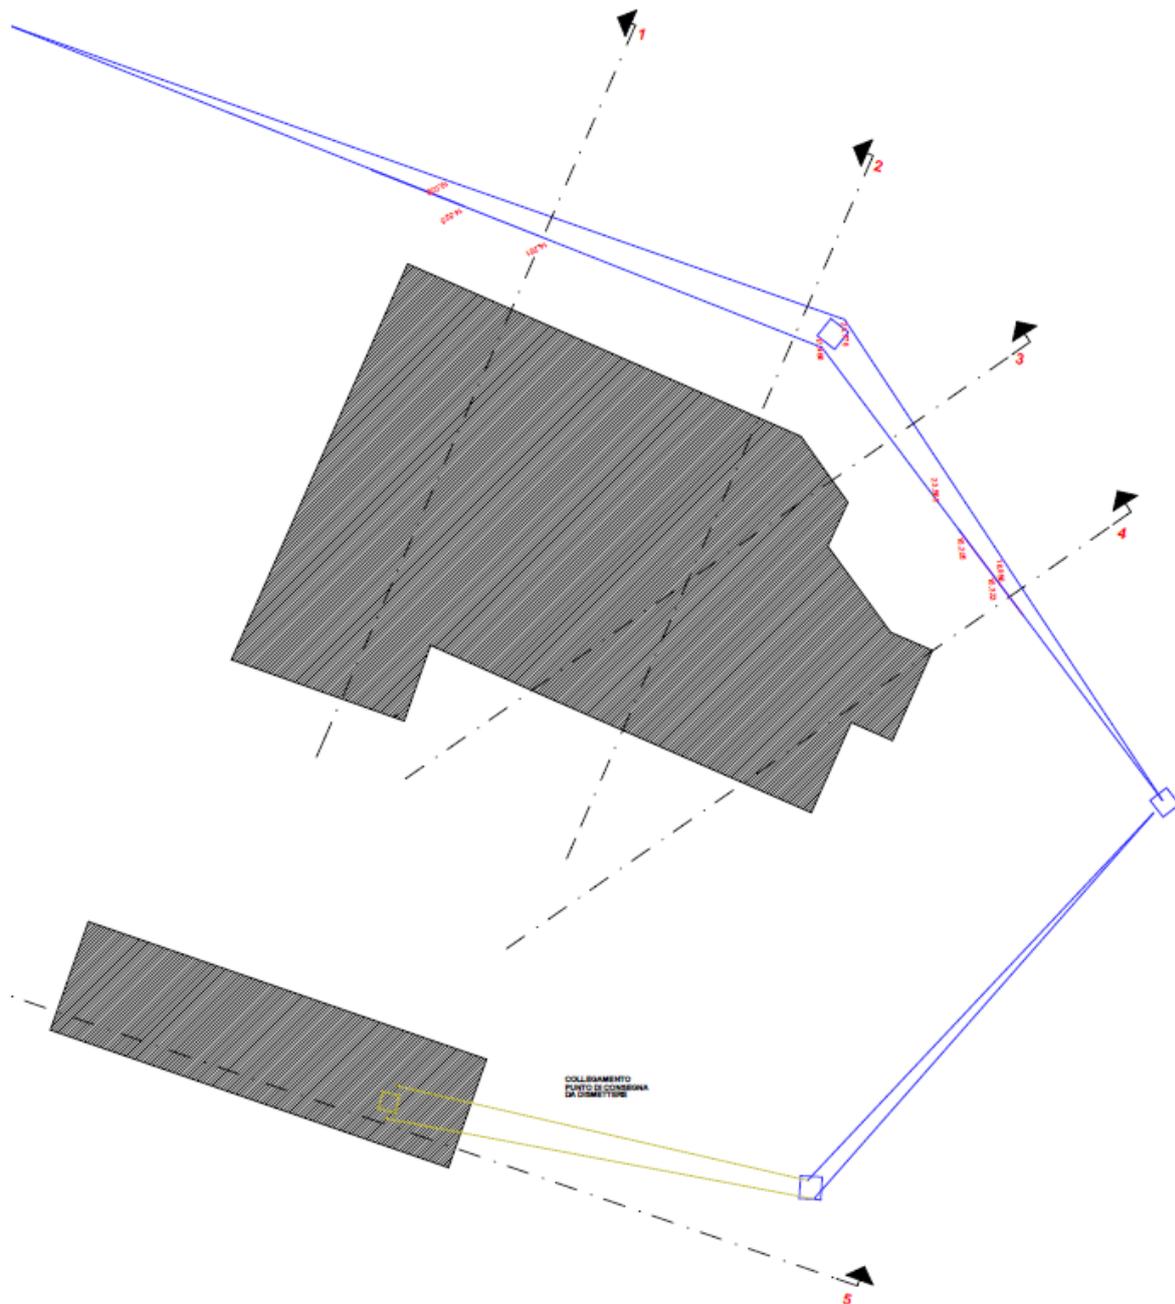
Planimetria del nuovo edificio del Lotto1 e dell'elettrodotto
